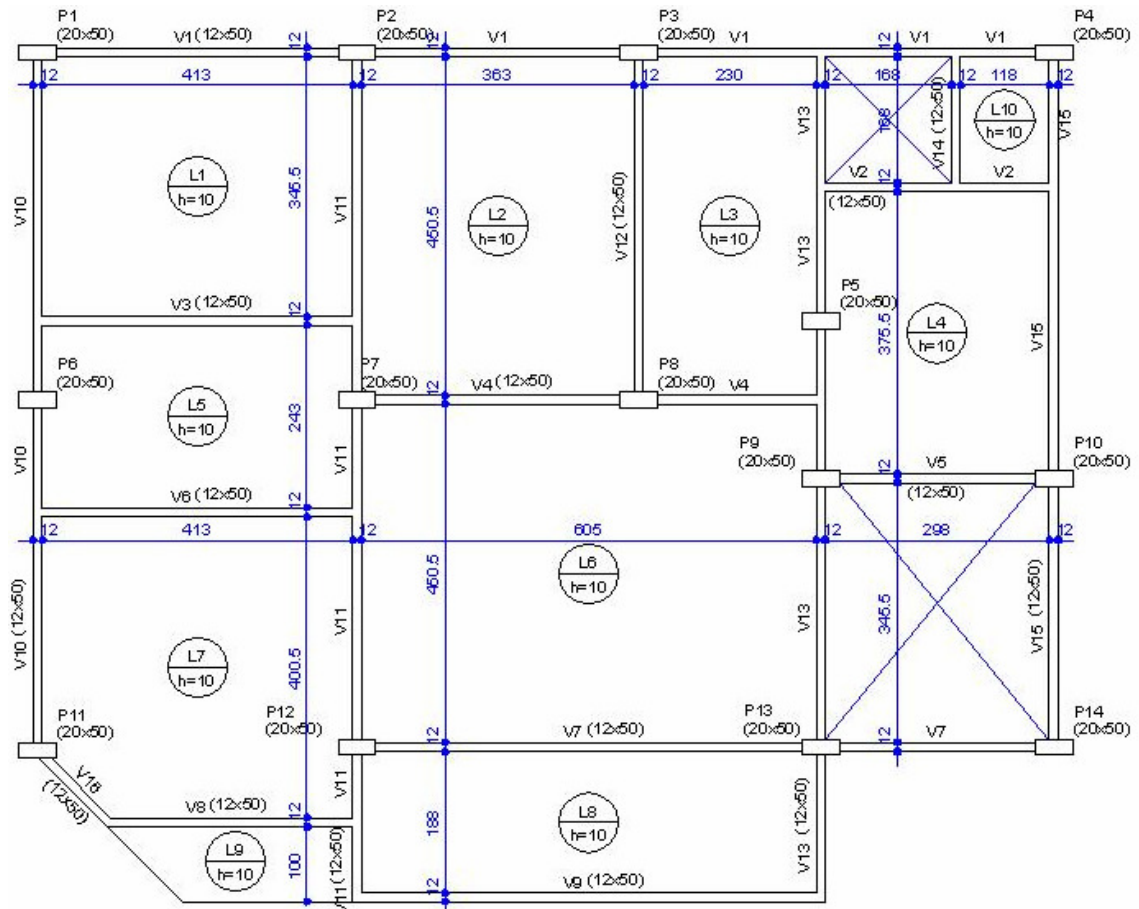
planta de fôrmas com as dimensões empregadas nos elementos.
